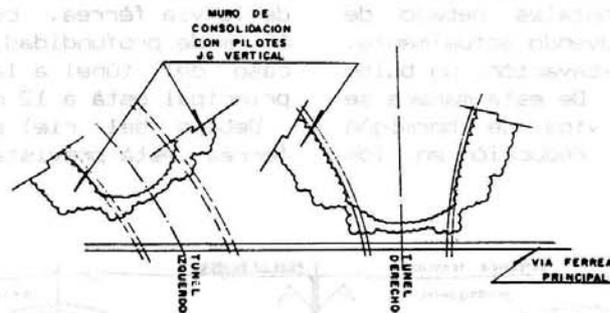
PLANTA DE LA EMBOCADURA EN ARCO
